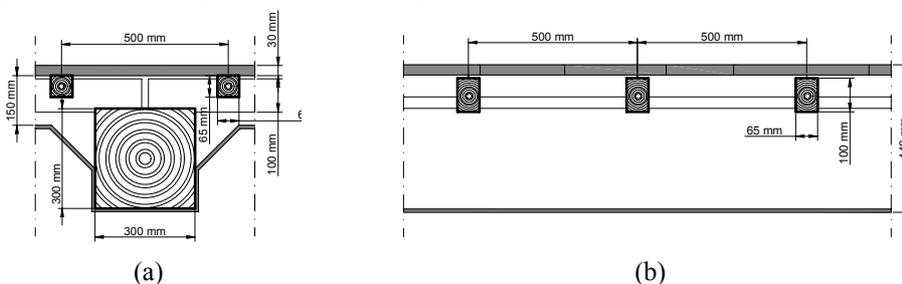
Secção resistente do pavimento em estudo: (a) corte transversal do vigamento principal; e (b) corte transversal do vigamento secundário
